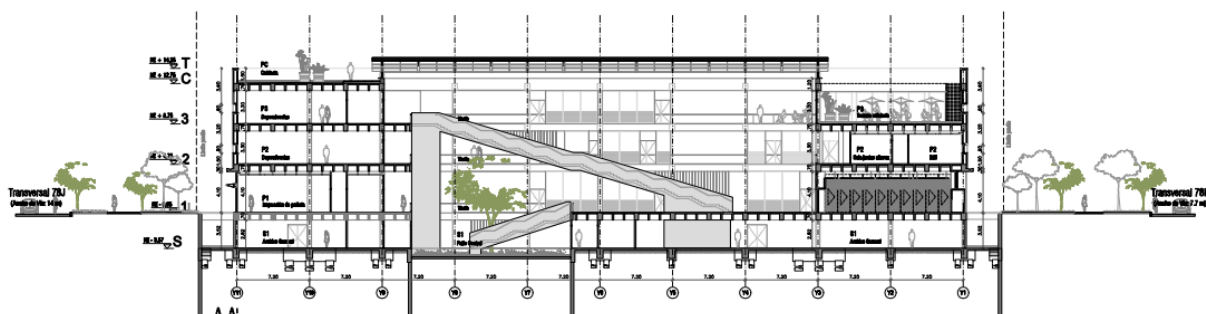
Corte Transversal. Fuente: Planos arquitectónicos.
